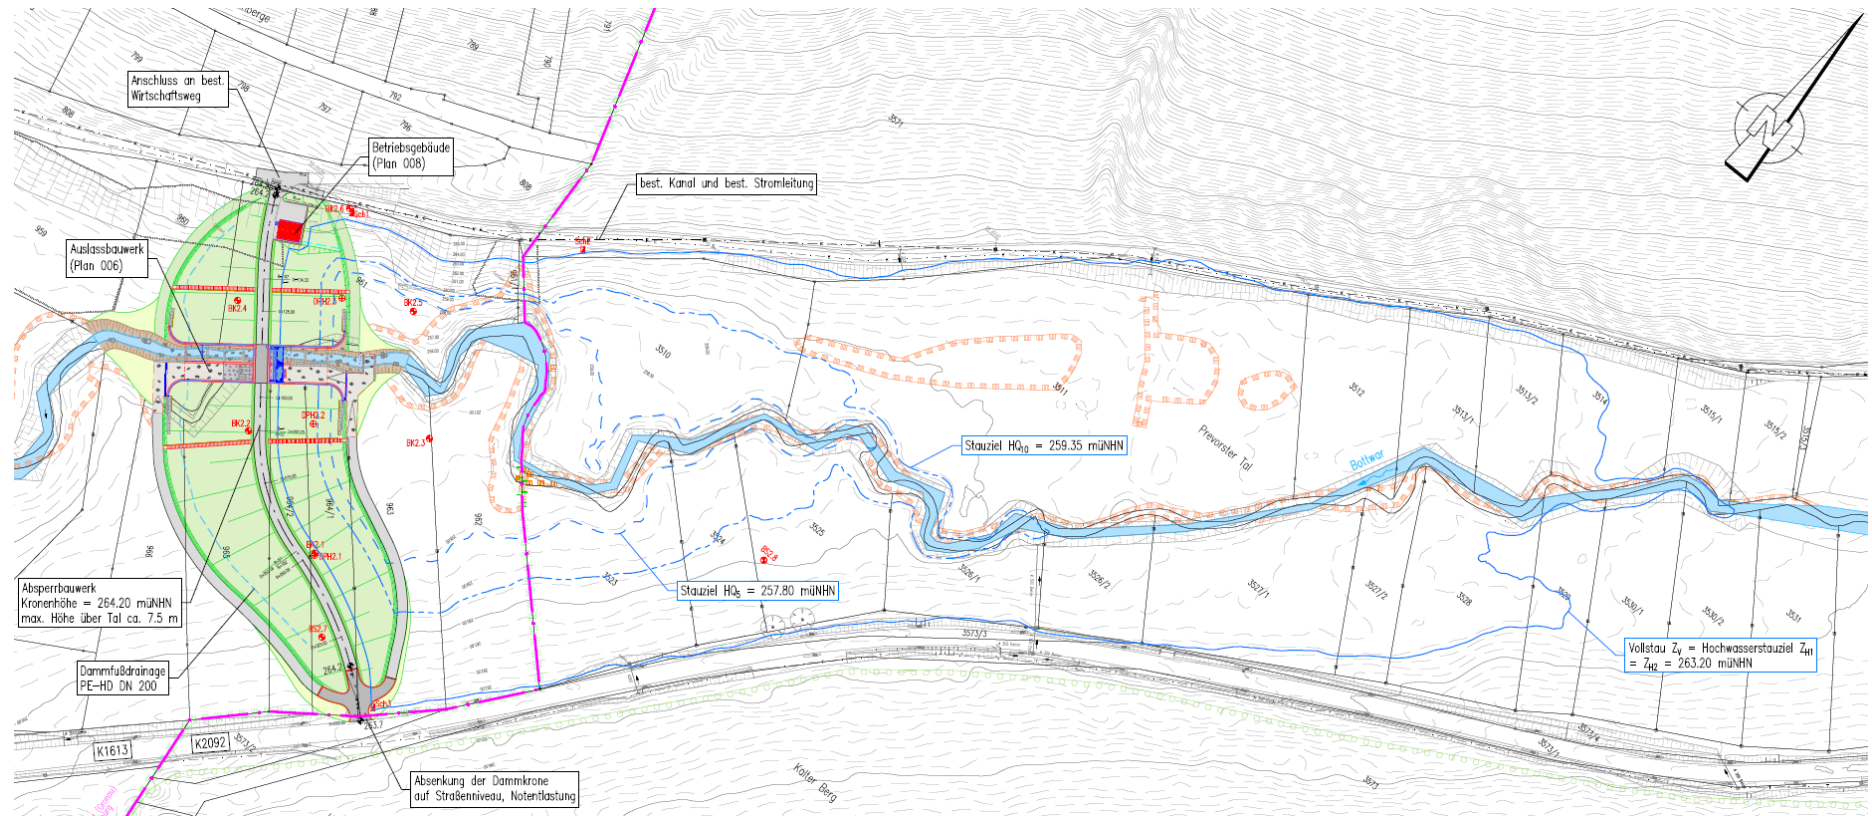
Unmaßstäblicher Lageplan des Dammbauwerkes mit Überflutungsflächen (Detaillierter Darstellung siehe Unterlage Lageplan siehe Unterlagen Teil B Plan 002, INGENIEURBÜRO WINKLER UND PARTNER, 2019/2020)
